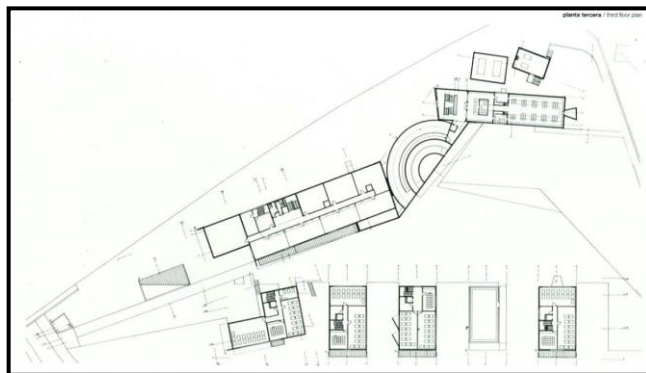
Planta conjunto del Proyecto con sus diferentes espacios e inmuebles.
